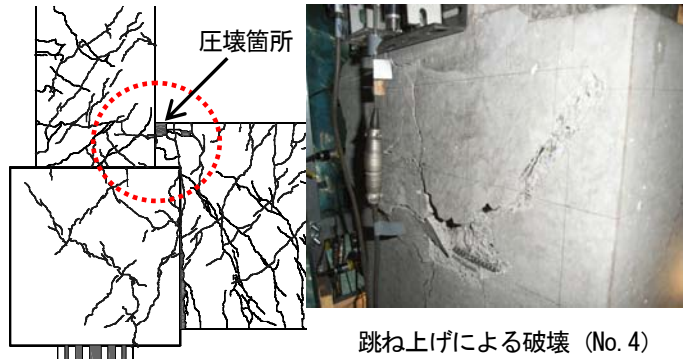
終局時ひび割れ状況 (試験体 No. 2, No. 4)
